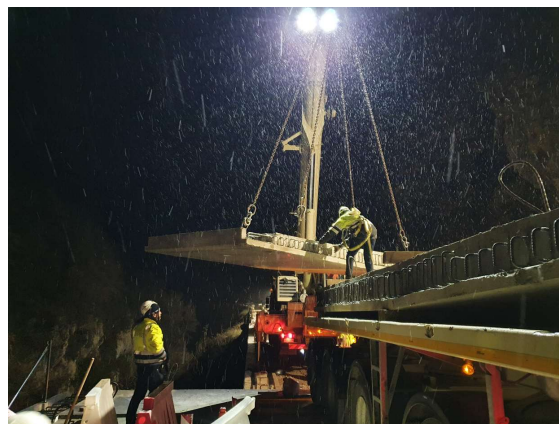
Izado y colocación de placa prefabricada en corte nocturno de tráfico.
